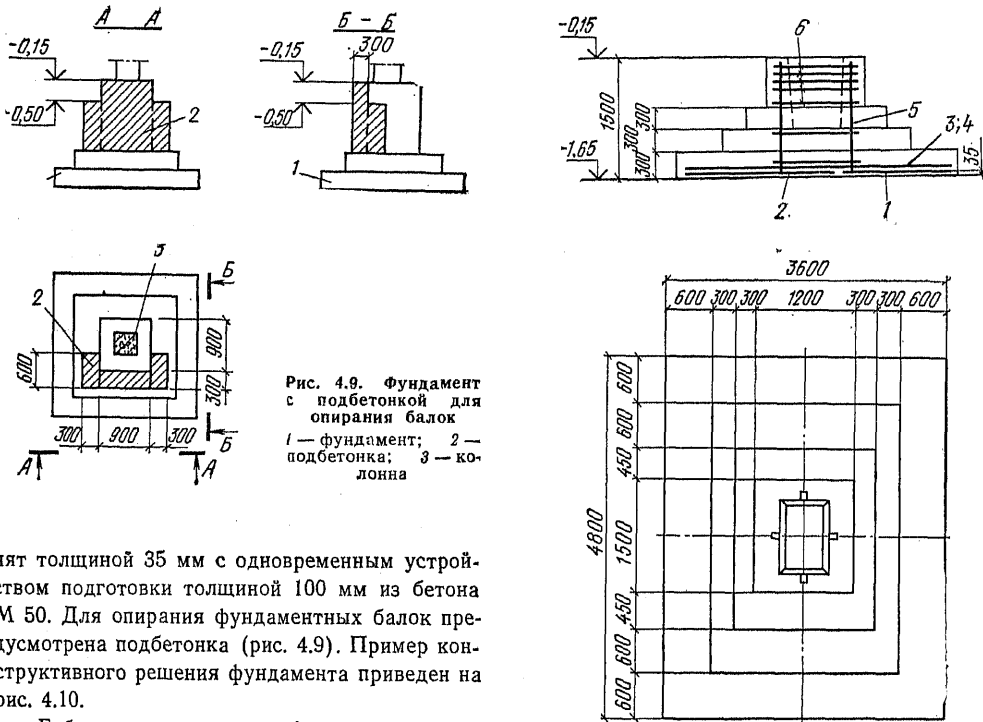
Фундамент с подбетонкой для опирания балок
